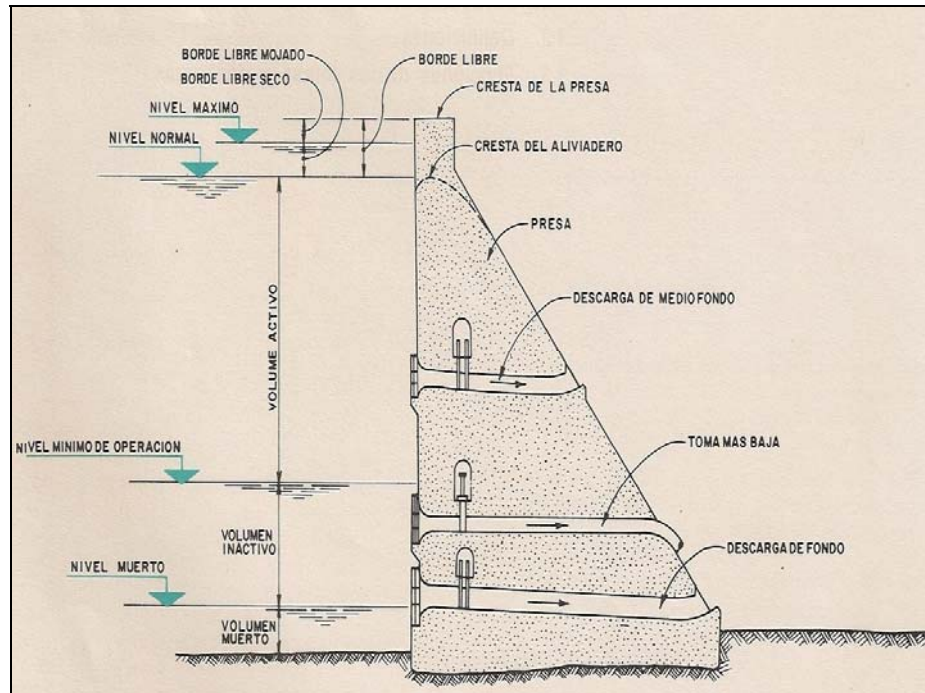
Definición de términos. Fuente: Ingeniería de Presas, p. 2, Suarez.
